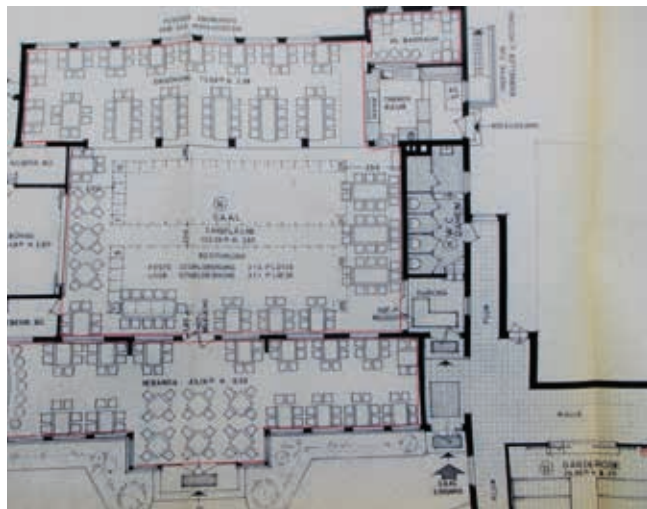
Grundriß Erdgeschoß, 1965 (StAL-GA 203)
